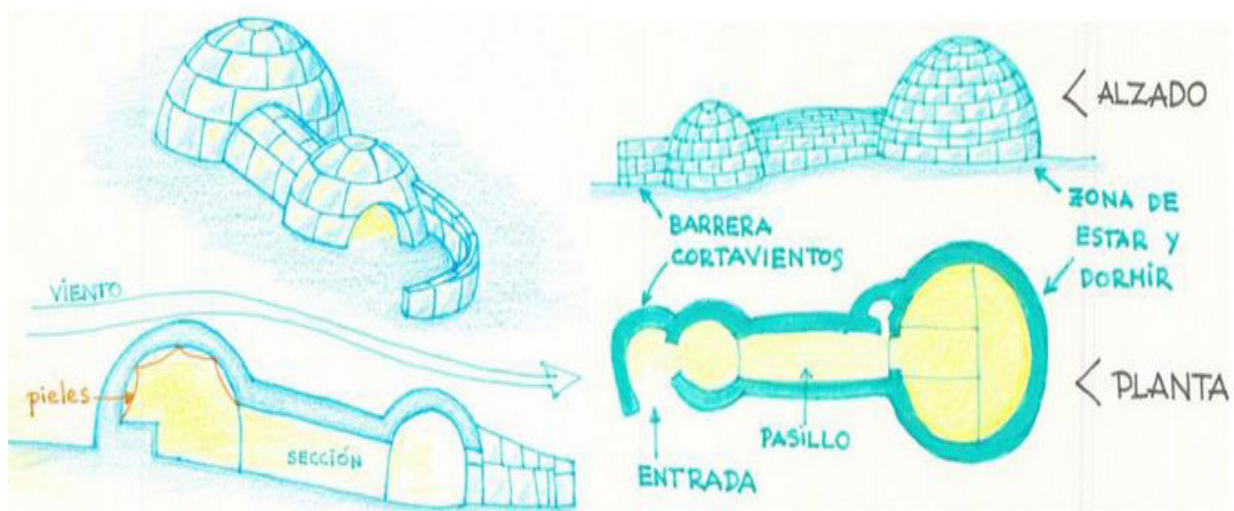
, alzado y planta característica de un Iglú (2014) Fuente: recursos electrónicos.
